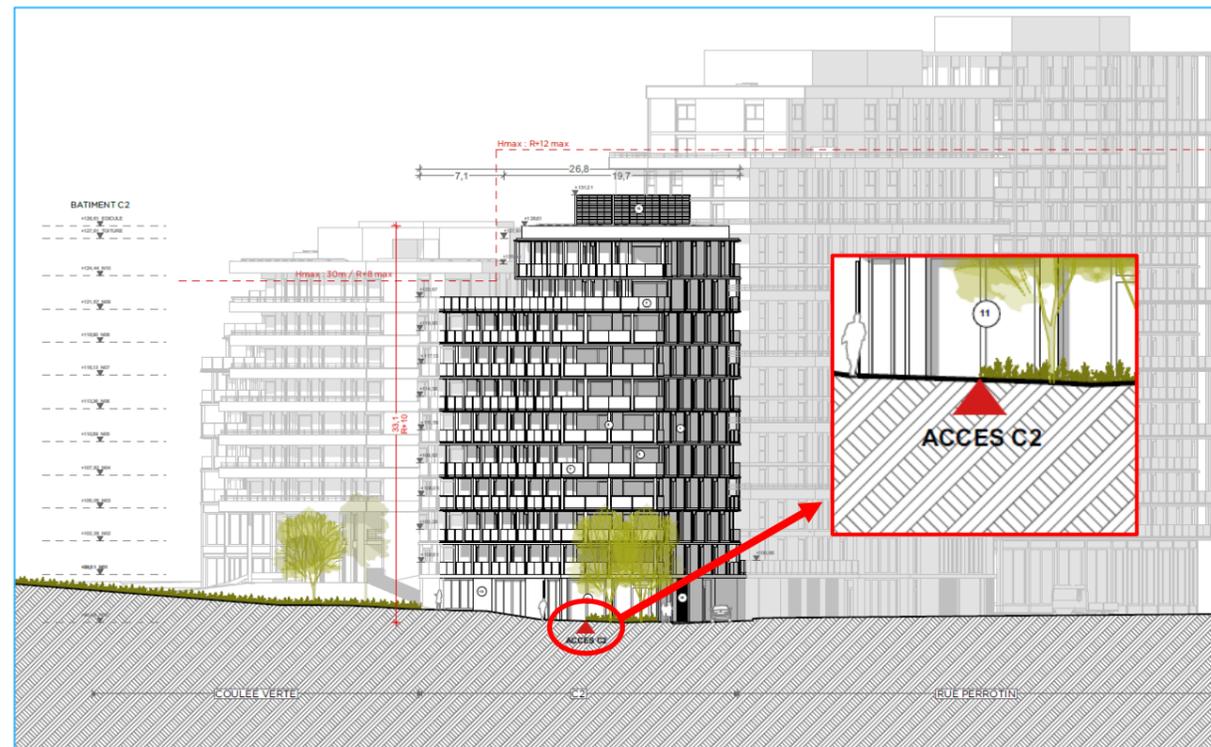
Coupe longitudinale de la façade à l'angle de la coulée verte et de la rue Perrotin (Source : PPX Architecture)
